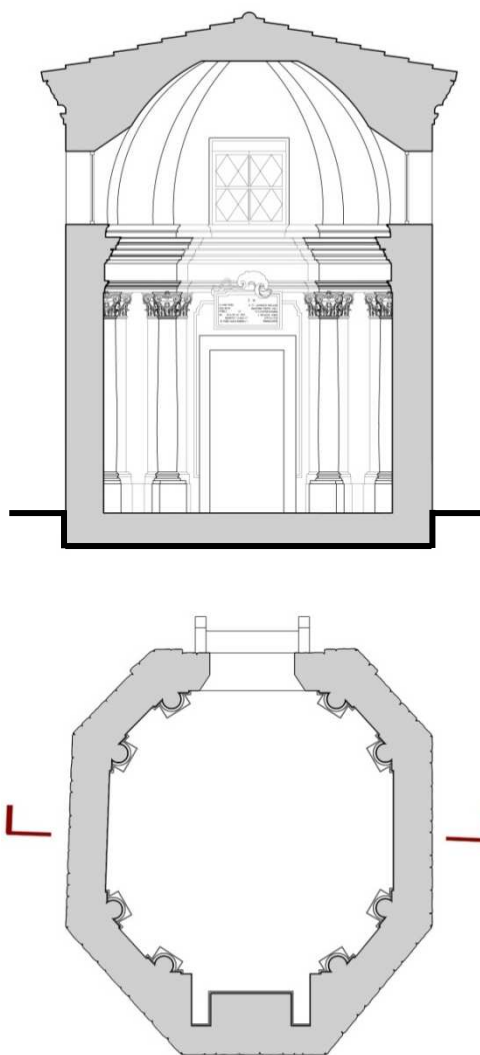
Pianta e sezione della Chiesa attuale risalente al 1765.
